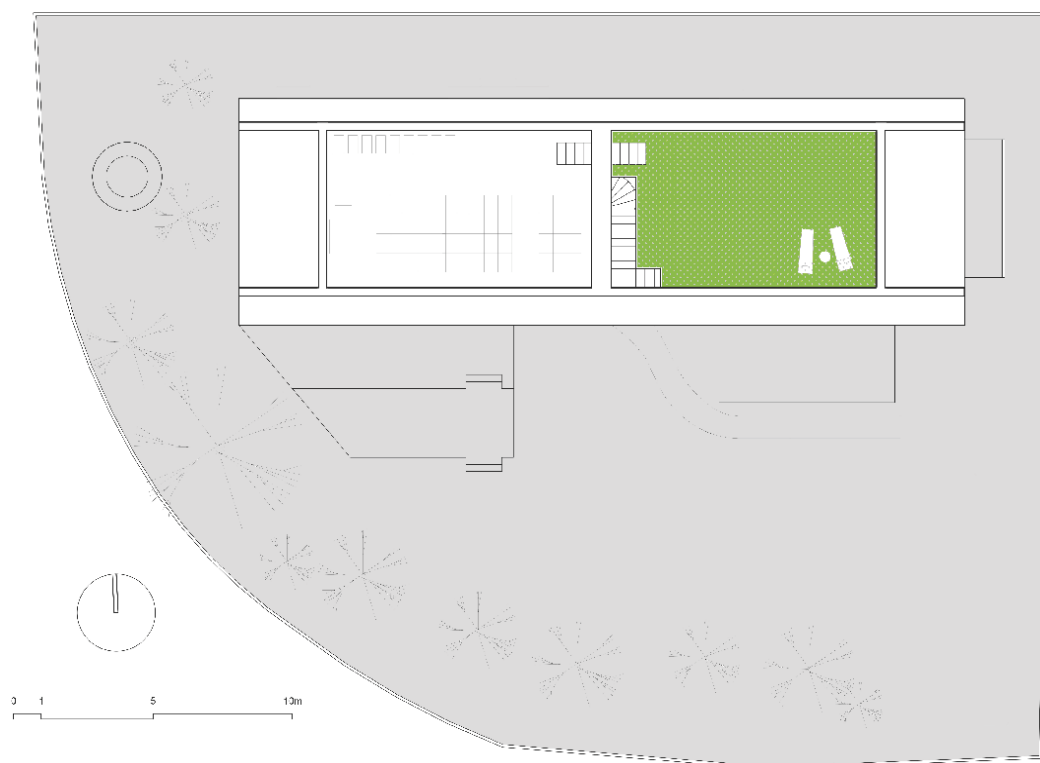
Planta da cobertura. Fonte: AUTOR (2017).
